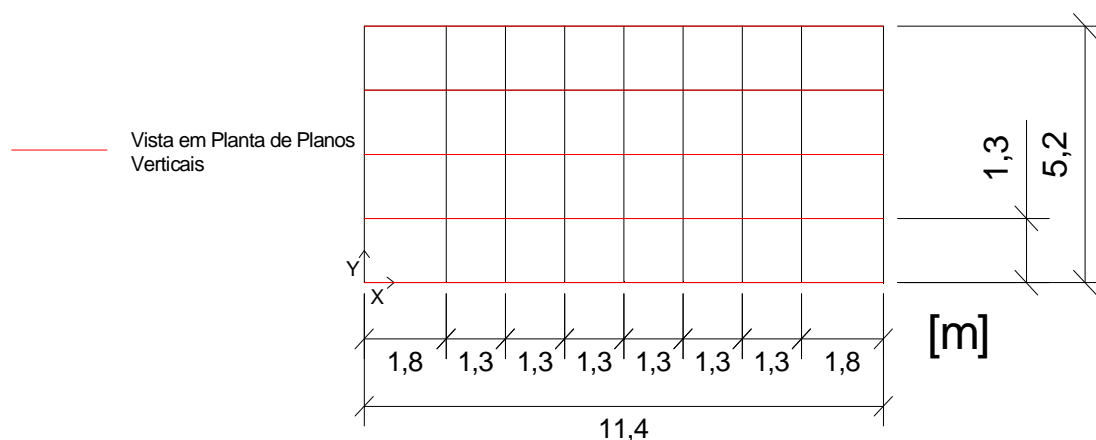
Vista em Planta dos Planos Verticais no Cembre ao Solo Para Uma Secção Tipo de Um Viaduto Com 20 m de Vão
